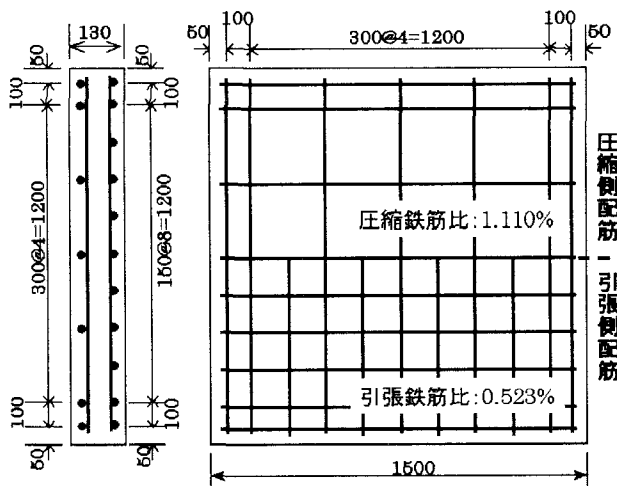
供試体の配筋図および断面図 (20・40-1/2As-1,2)
